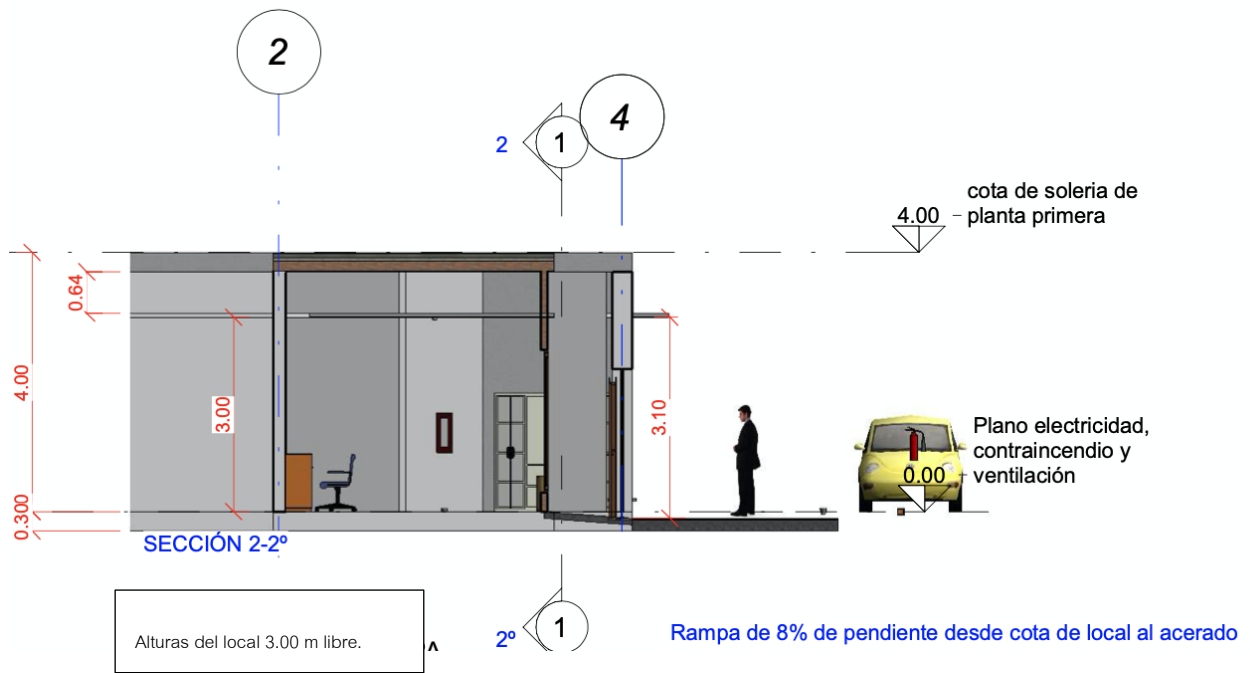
Plano de sección 2. Fuente: Propia y Revit®
